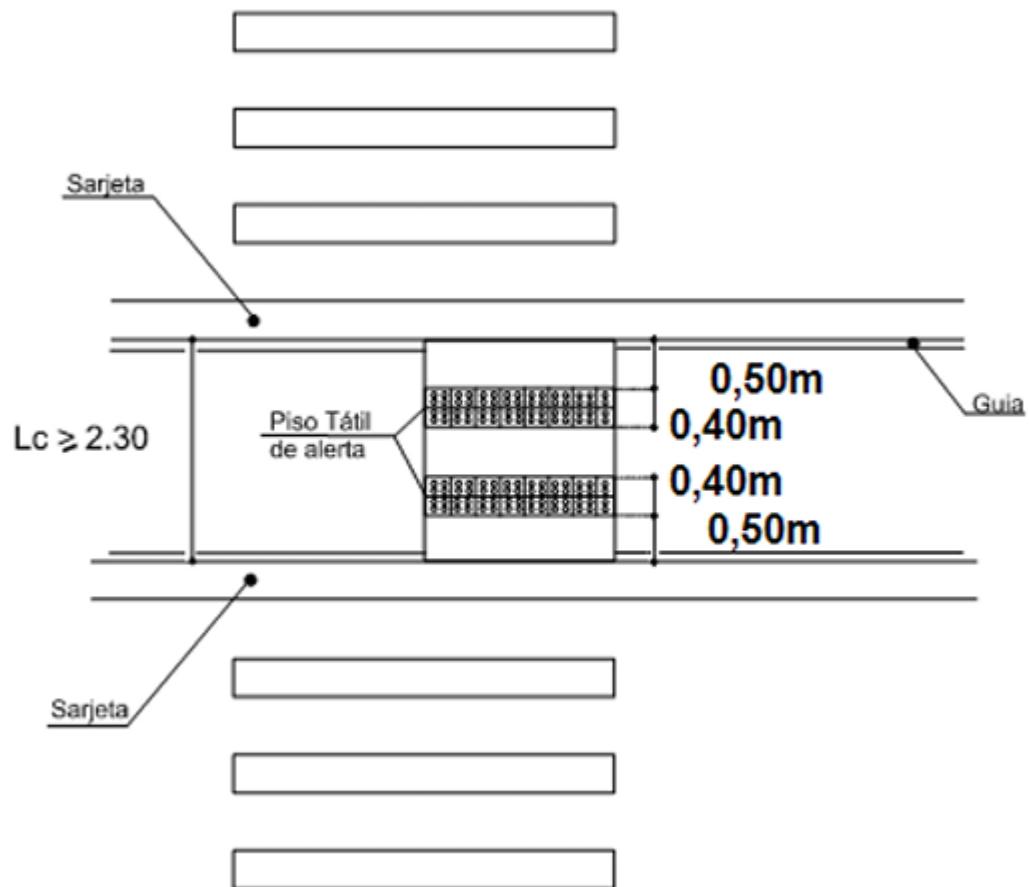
Planta - Rebaixamento em canteiro central superior a 2,30m.
